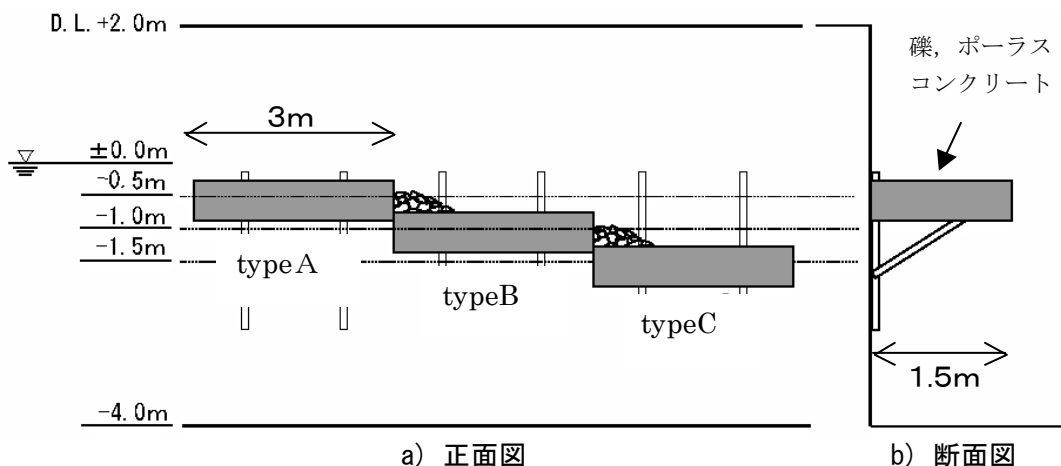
構造物の正面図，断面図およびポーラスコンクリート，礫の配置方法
